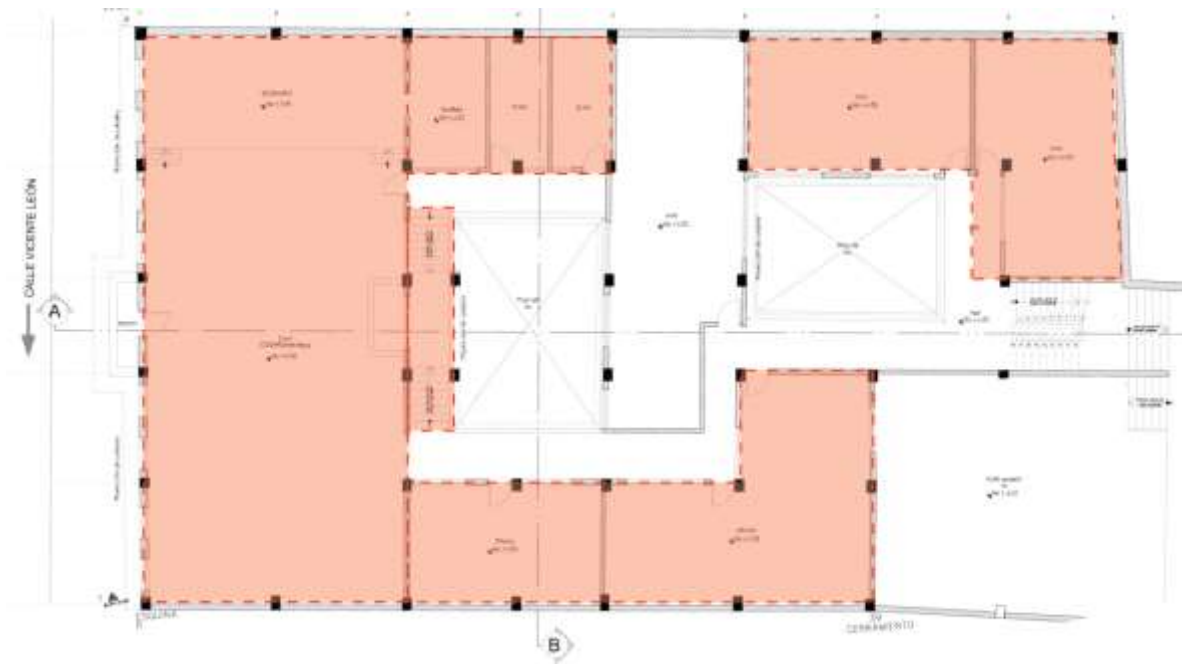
Planta de segundo nivel, estado actual, se marcan los espacios que se van a intervenir
